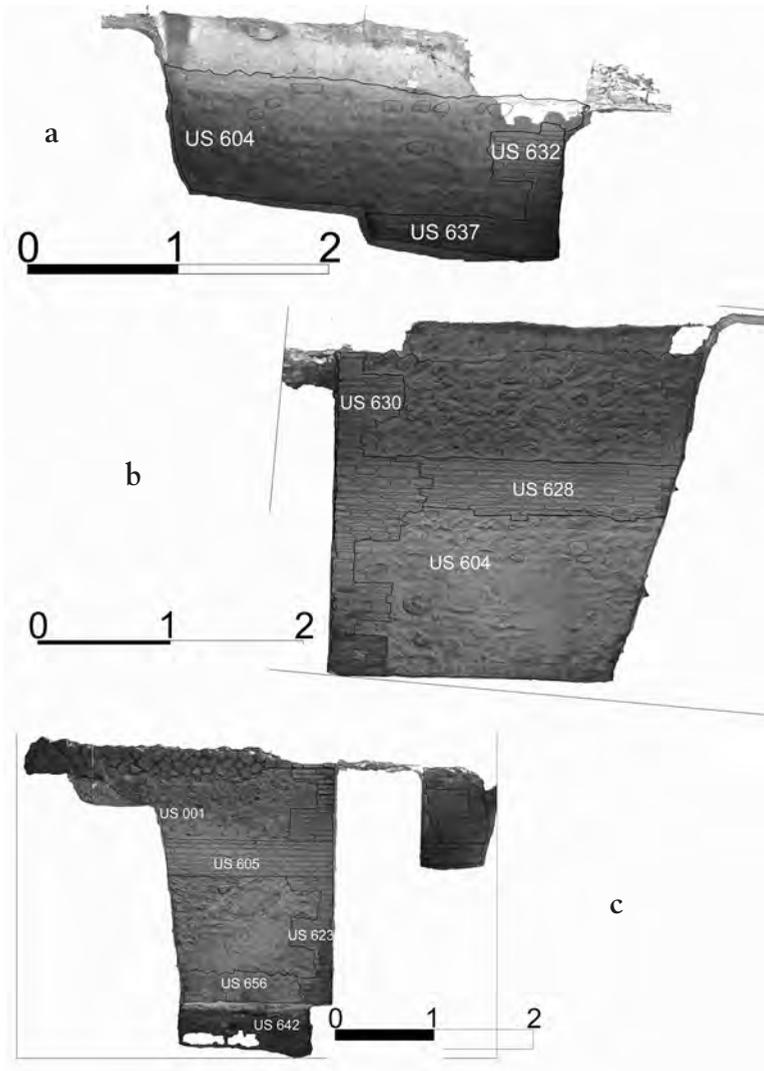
Prospetto dell'elevato meridionale del podio in cui sono visibili i resti della prima fase costruttiva (US 656) e i rifacimenti successivi (UUSS 001, 605, 623). In basso, invece, la fondazione della struttura del podio (US 642). Prospetto del lato occidentale della struttura di delimitazione della cella di cui si riconoscono le porzioni in opera incerta (US 604) divise dalla catena (US 628). Si segnala la sarcitura (US 630) che invade la catena mediana. Prospetto del lato orientale della struttura di delimitazione della cella in cui è visibile la porzione in opera incerta (US 604) e parte della sarcitura (US 632) e della catena mediana (US 637).
